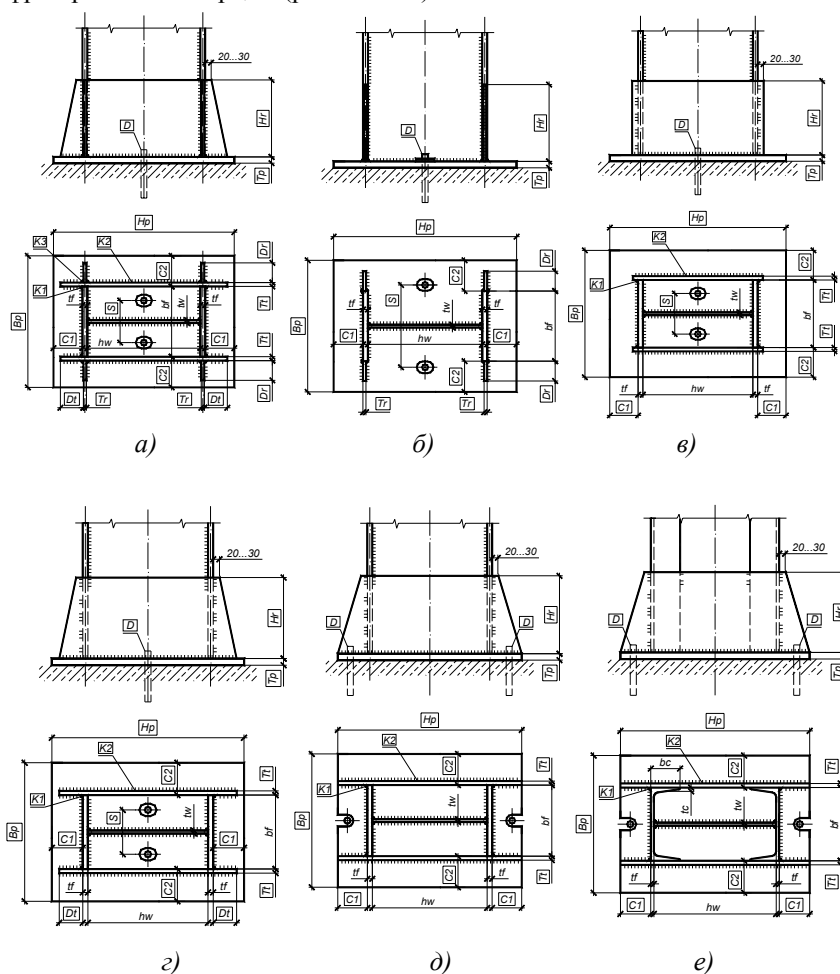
Типы конструктивных решений шарнирных баз колонн с траверсами и консольными ребрами.
